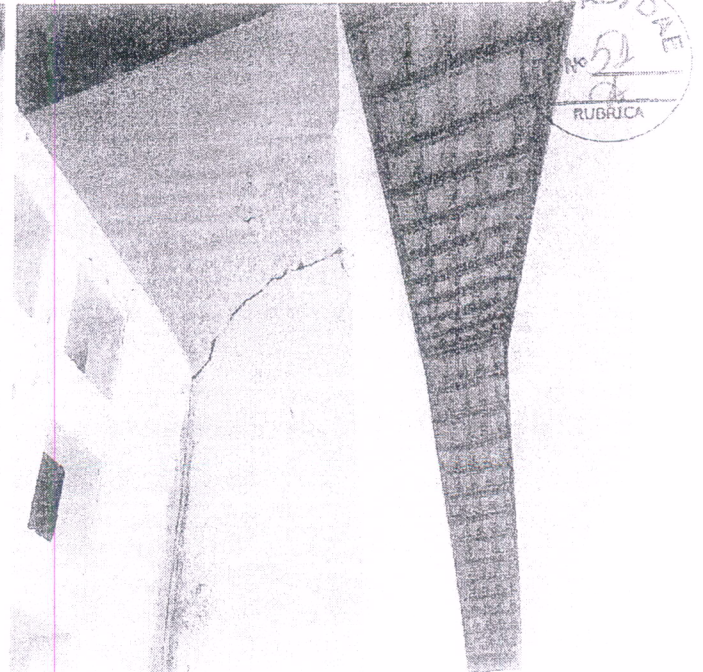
Fissuras inclinadas nas alvenarias dos dormitórios junto à parede de cobogós que fecha a área de jardim.
